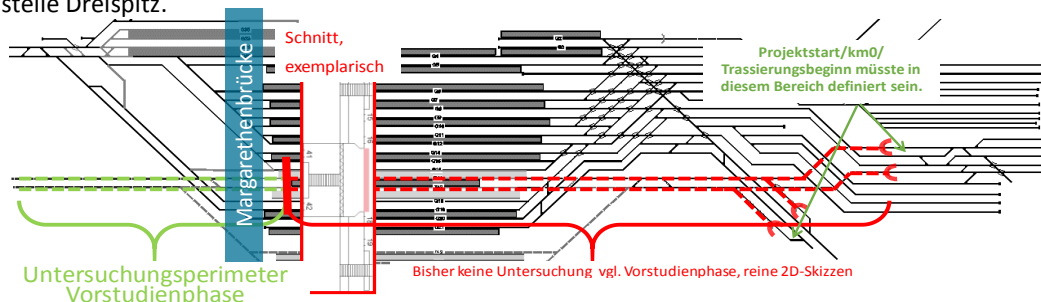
Grüner Projektierungsperimeter aus der Vorstudienphase (links/Höhe Margarethenbrücke/Passerelle) und roter Perimeter mit reinem Gleisschema aus/ab dem 1. Ergänzungsbericht zum Rahmenplan 2013 [Quelle: Konsortium]
